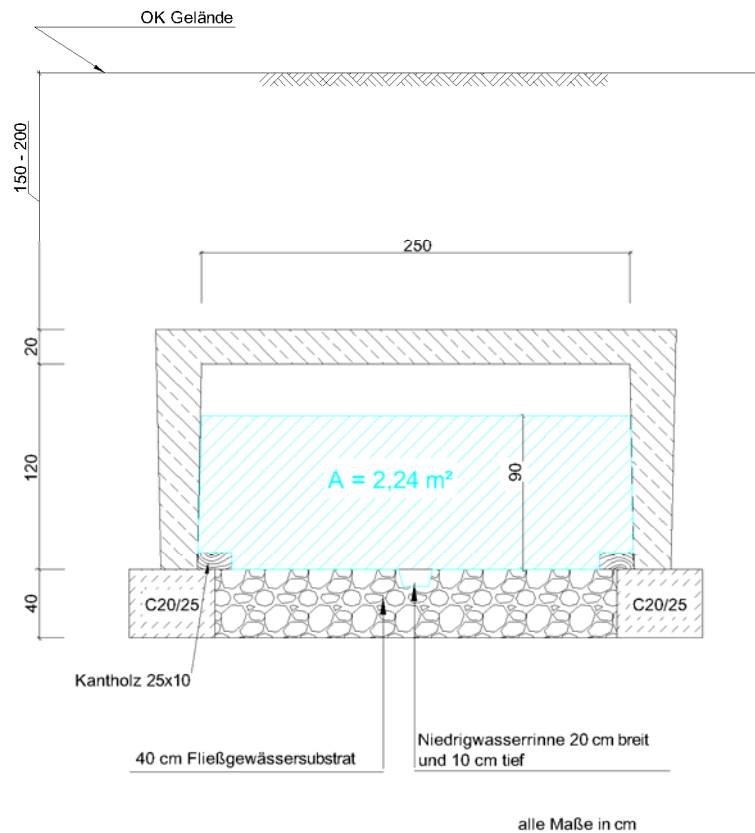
Gemauerter Durchlass des Stockheimer Baches unter der B 275 im GESIS-Abschnitt 27
